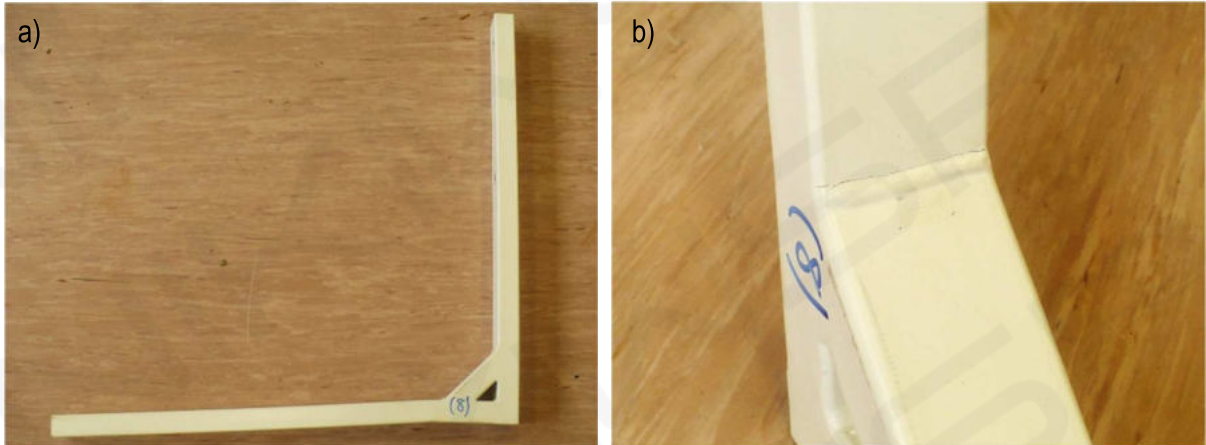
Widok zniszczonego elementu P5: a) widok ogólny, b) miejsce zniszczenia
